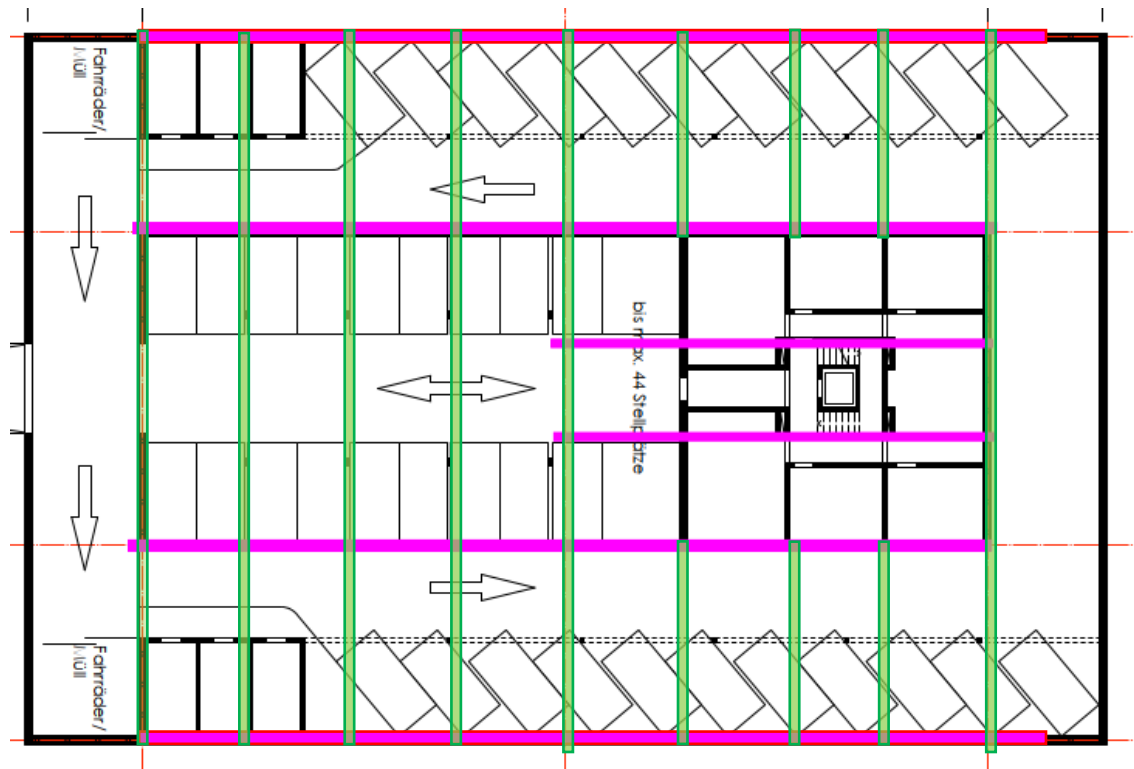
Tragsystem Modul Hohldeckel im Fall Tiefgarage, magenta: Hauptträger geschossene Wände, grün: Nebenträger
